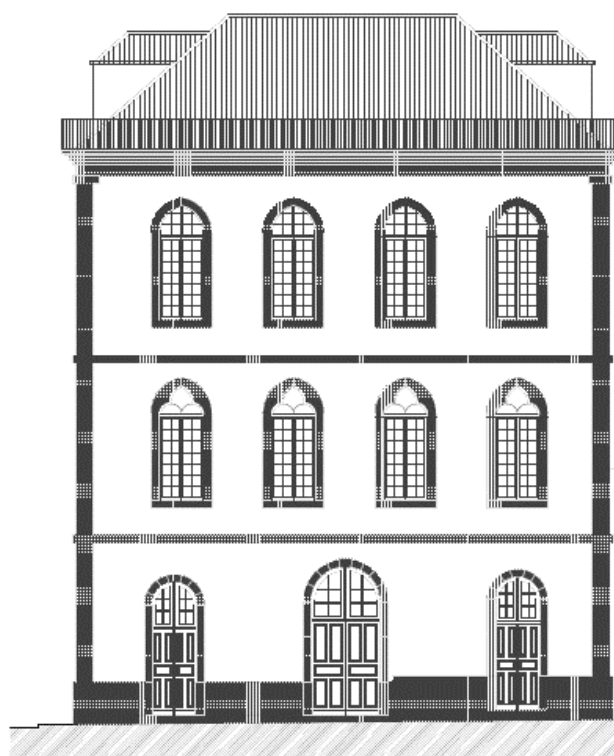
Alçado principal proposto – Esc. 1/200 – Autora do projeto
